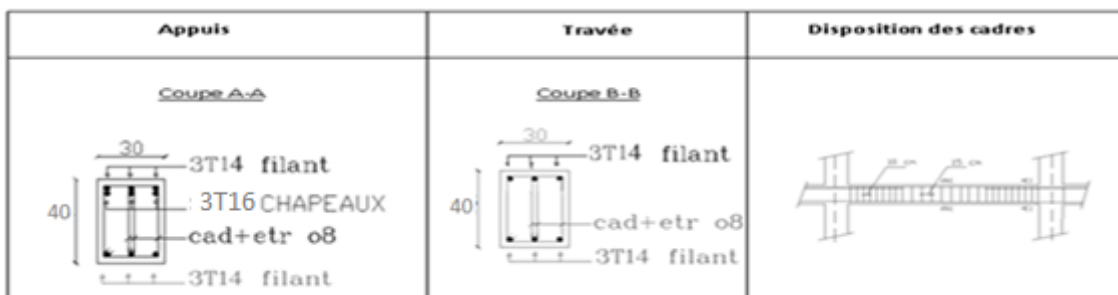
Coupe transversale de ferrailage des poutres principales (E. courant)
